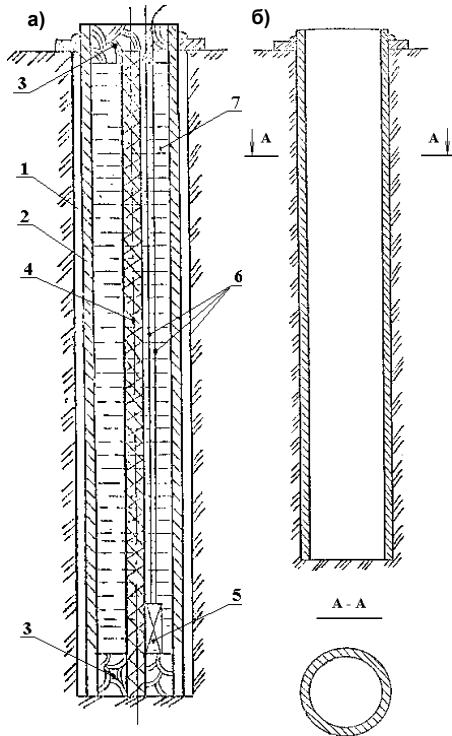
Конструкция трубной заготовки (а) и трубчатого анкера ТА1 (б): 1 – шнур; 2 – трубная заготовка; 3 – глиняная пробка; 4 – детонирующий шнур ДША или ДШВ; 5 – электродетонатор; 6 – электропровода; 7 – наполнитель (песок, вода)
